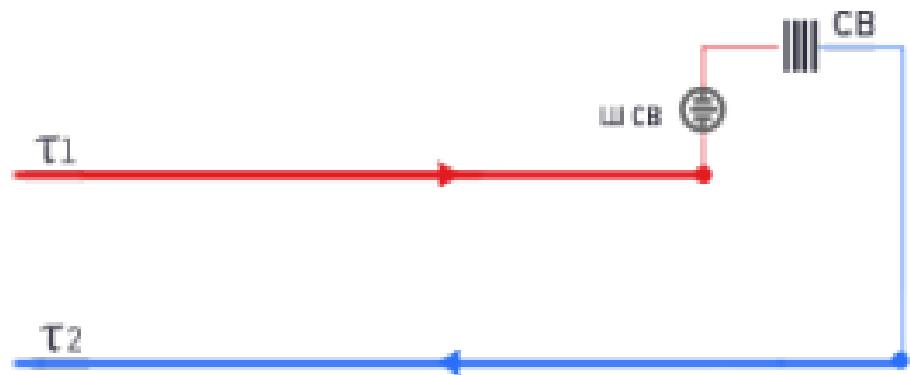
Потребитель вентиляционной нагрузкой (схема № 25)
